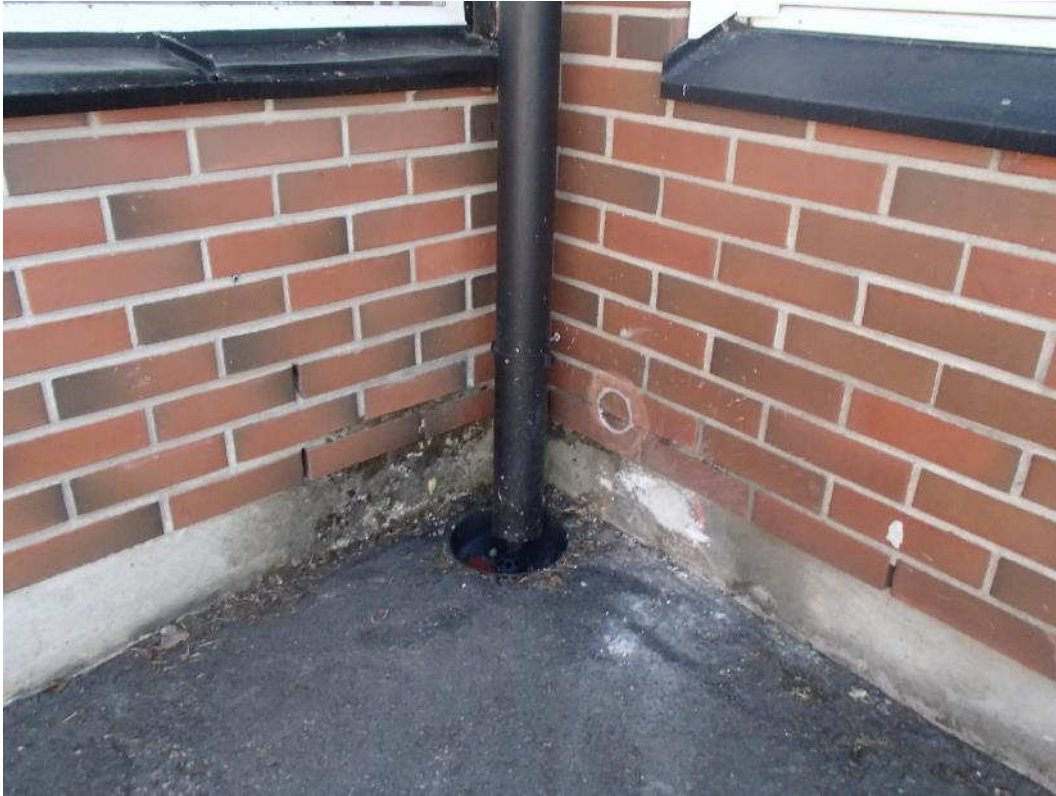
Sokkelit ovat paikoin pahoin rapautuneet sekä sokkelissa on havaittavissa betoniteräskorroosiosta.
